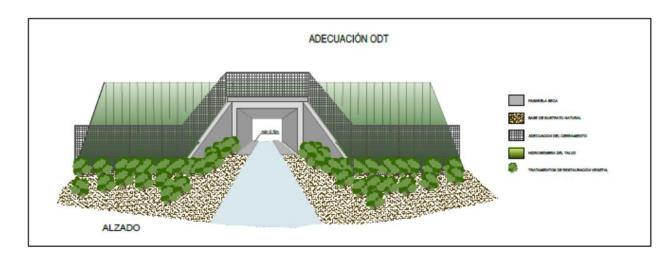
Detalle tipo de las adaptaciones en las Obras de Drenaje Transversal.
